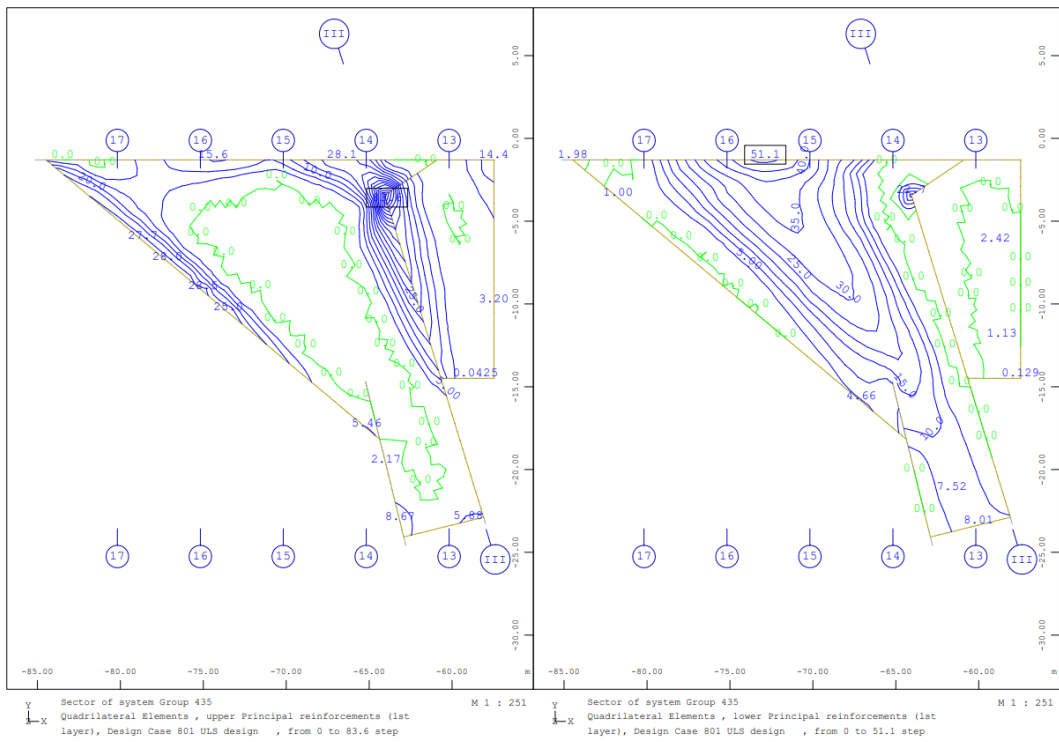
Armadura principal na face superior (esq.) e inferior (dir.) – laje de cobertura – acesso Sul - ELU
